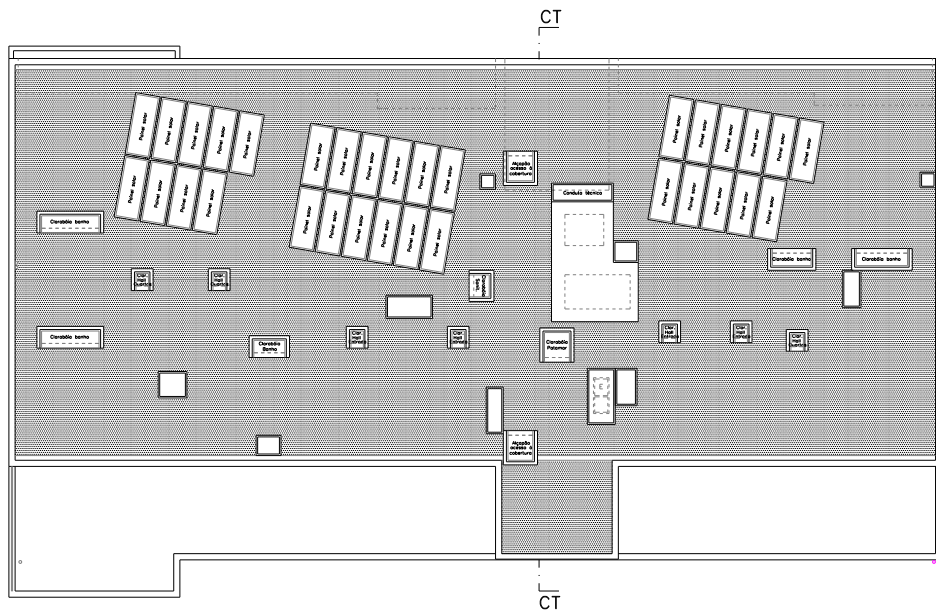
Planta da cobertura não acessível e localização do corte transversal
